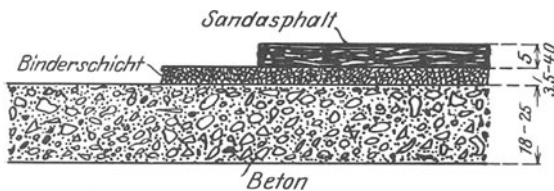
Sandasphalt auf Beton mit Binderschicht.
